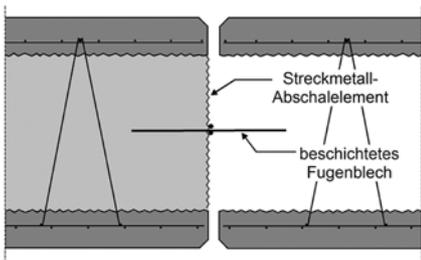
Streckmetallabschalung mit integriertem beschichtetem Fugenblech zur Herstellung einer vertikalen, »abgedichteten« Arbeitsfuge im Elementwandstoß
